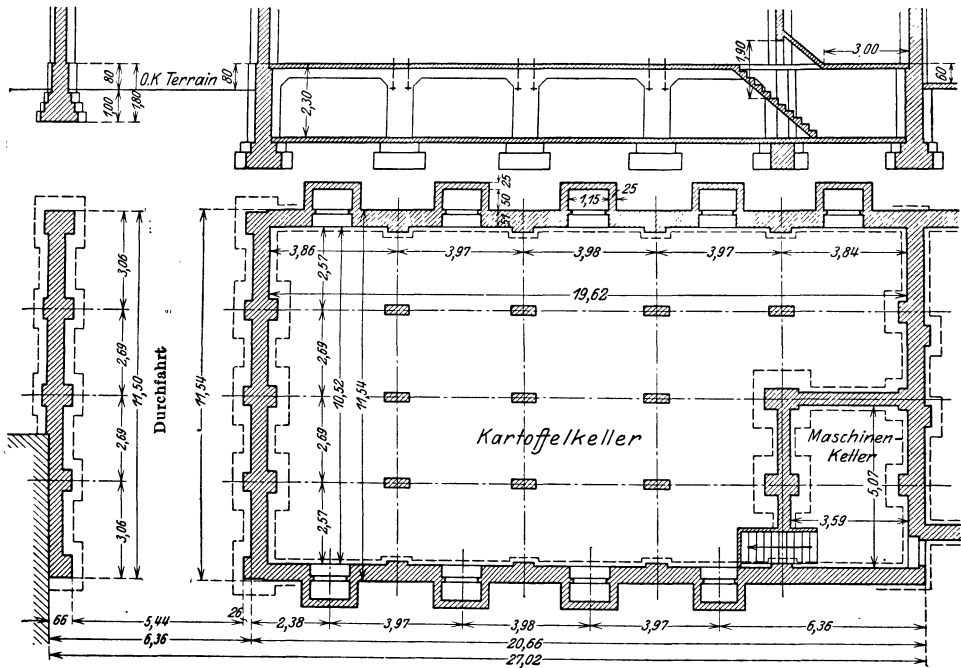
Speichergebäude Rittergut Kampehl. Grundriß und Längenschnitt des Kellergeschosses. (Ausführung: Ambi, Berlin.)
